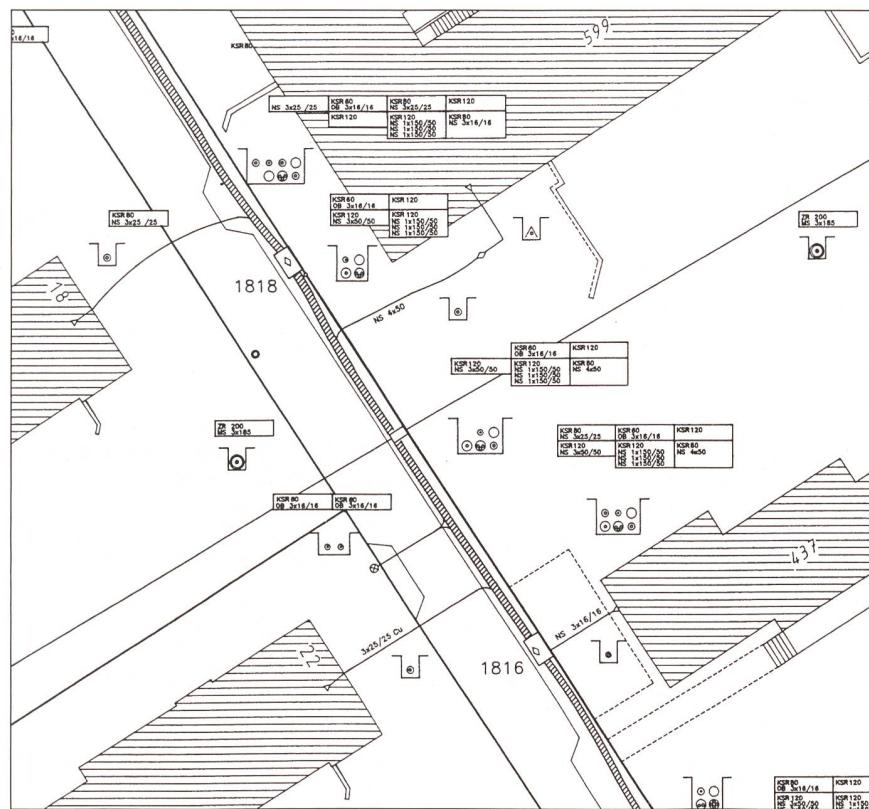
Ausschnitt aus einem Rahmenplan der Gemeinde Horgen (rund 400fach verkleinert).
